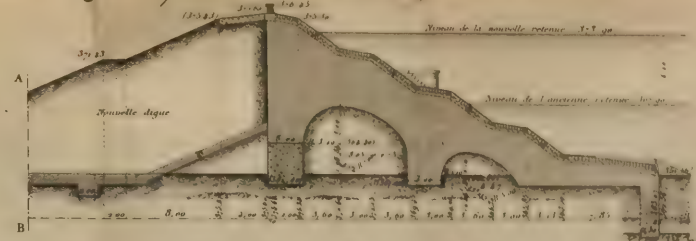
Coupe transversale de l'ouvrage de prise d'eau sur CD EF
